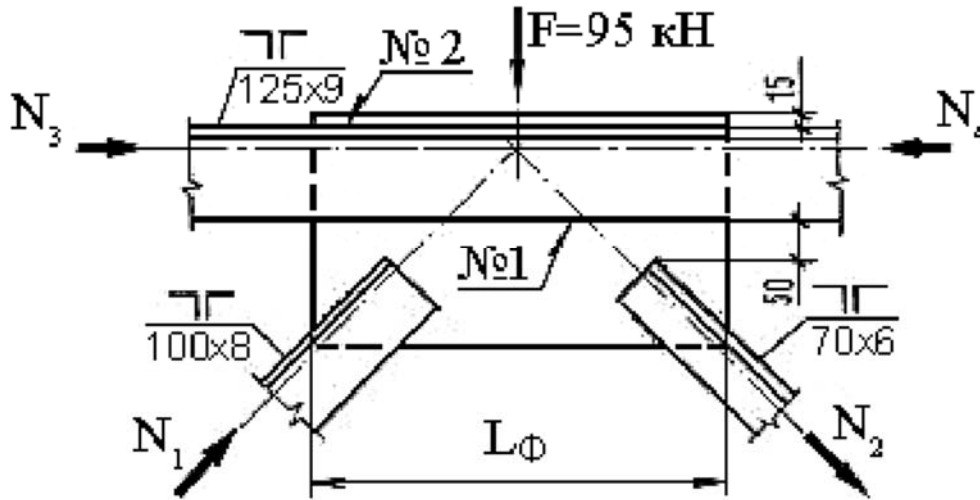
Узел сопряжения верхнего пояса фермы с раскосами
